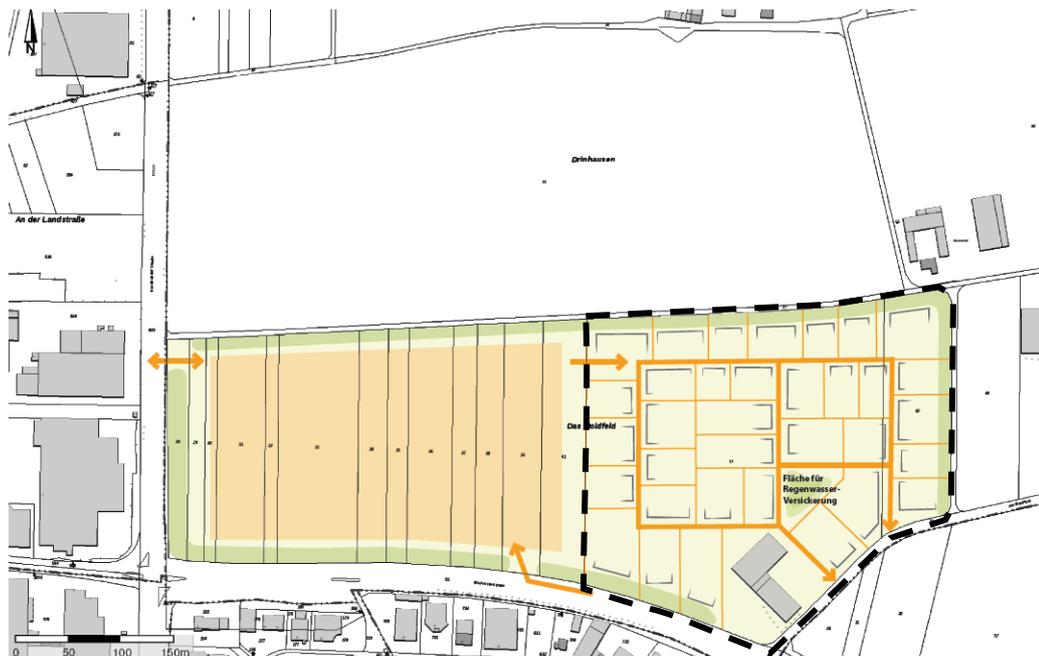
Städtebauliches Konzept inkl. Änderungsbereich (Änderungsbereich gestrichelt)
